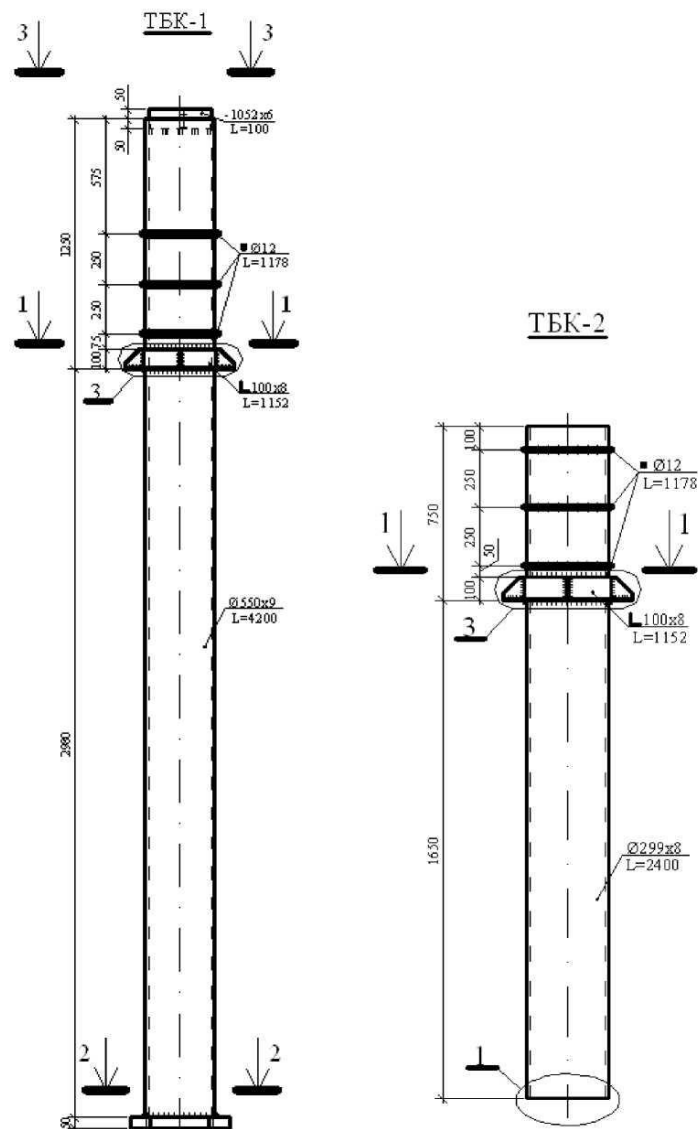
Загальний вигляд трубобетонних колон
